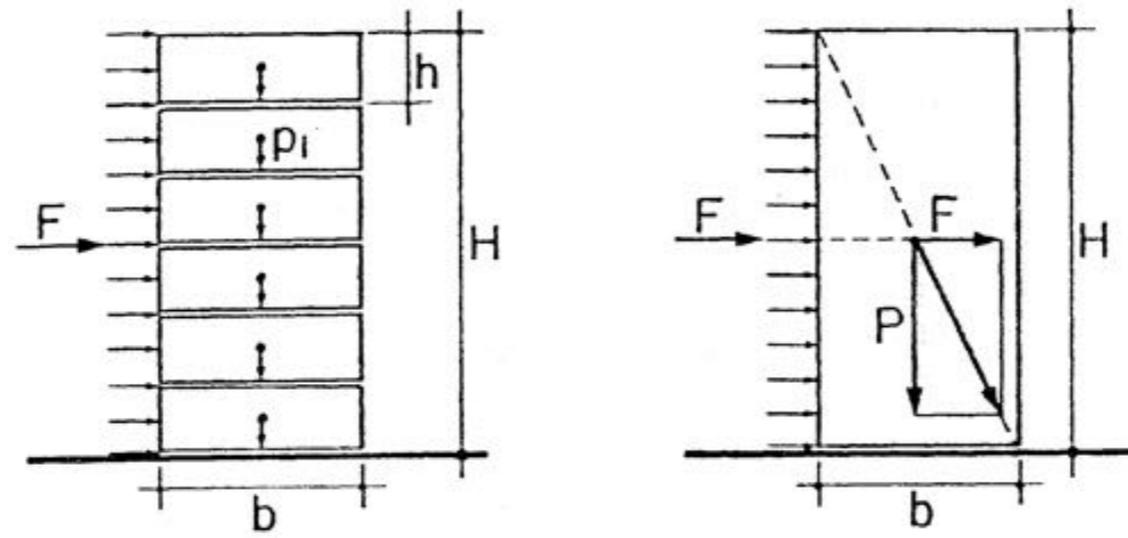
Schema di muro costituito da blocchi ad un filare con disposizione isodoma soggetto ad una forza orizzontale distribuita lungo l' altezza.
